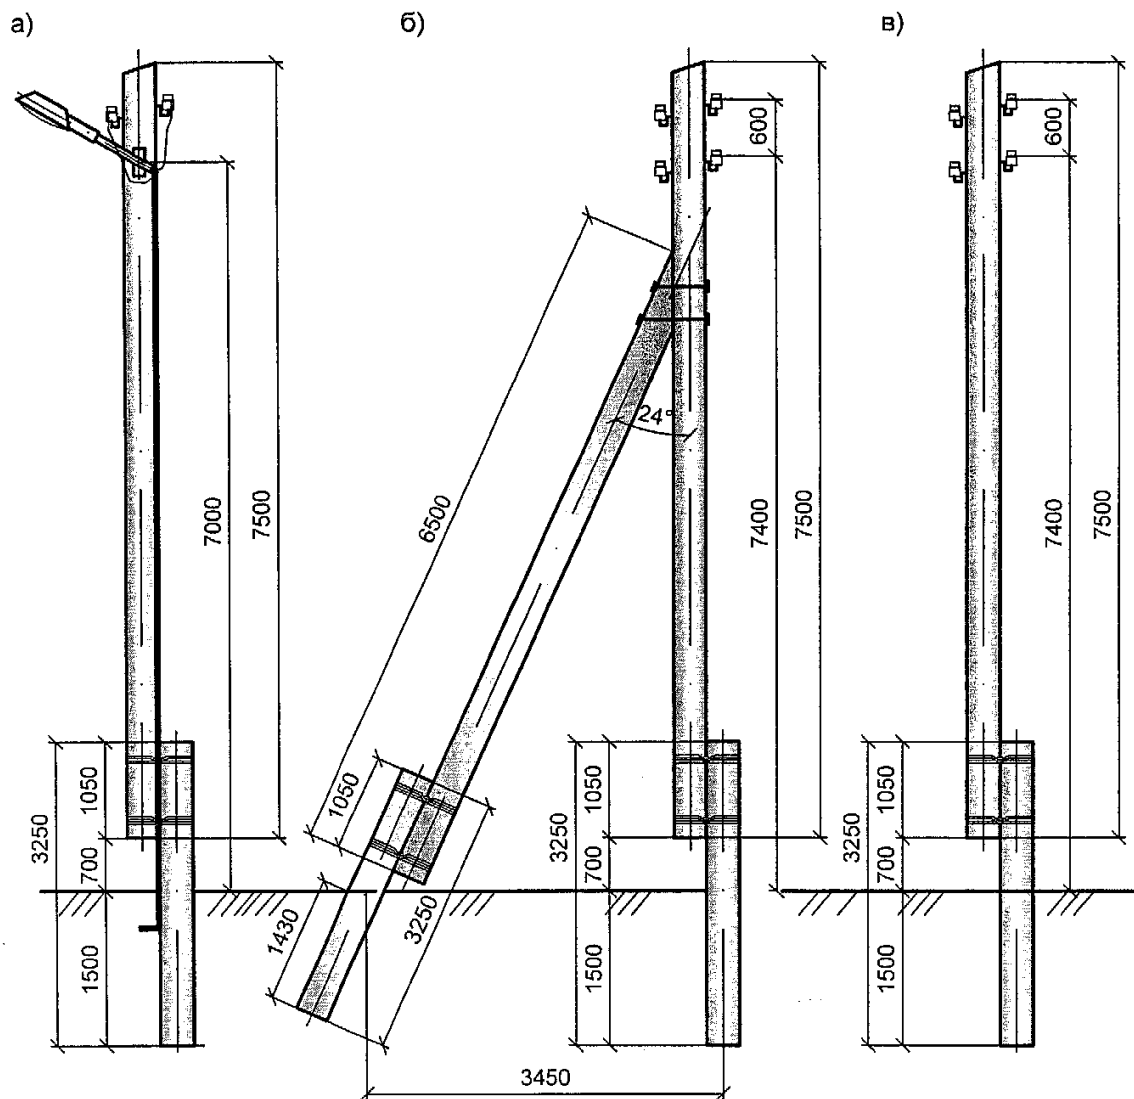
Схема освещения строительной площадки при помощи деревянных опор:
